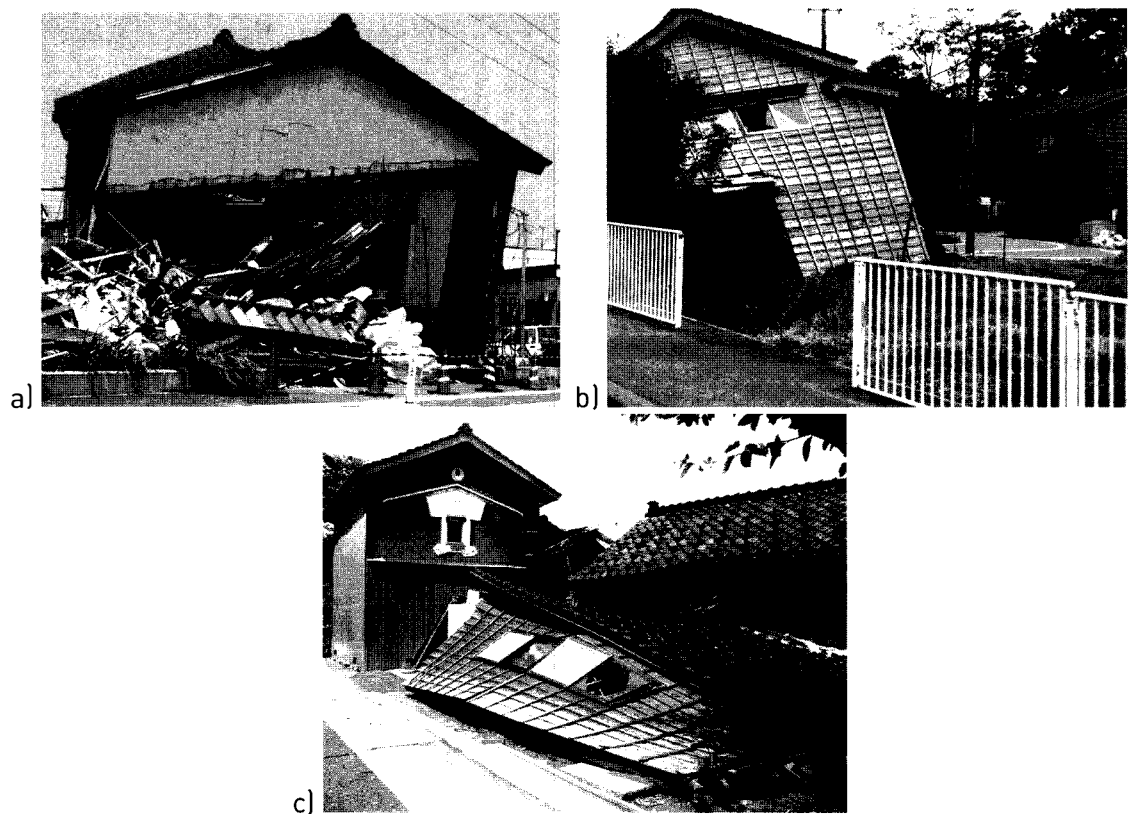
Ruine de structures par manque de contreventement des constructions
